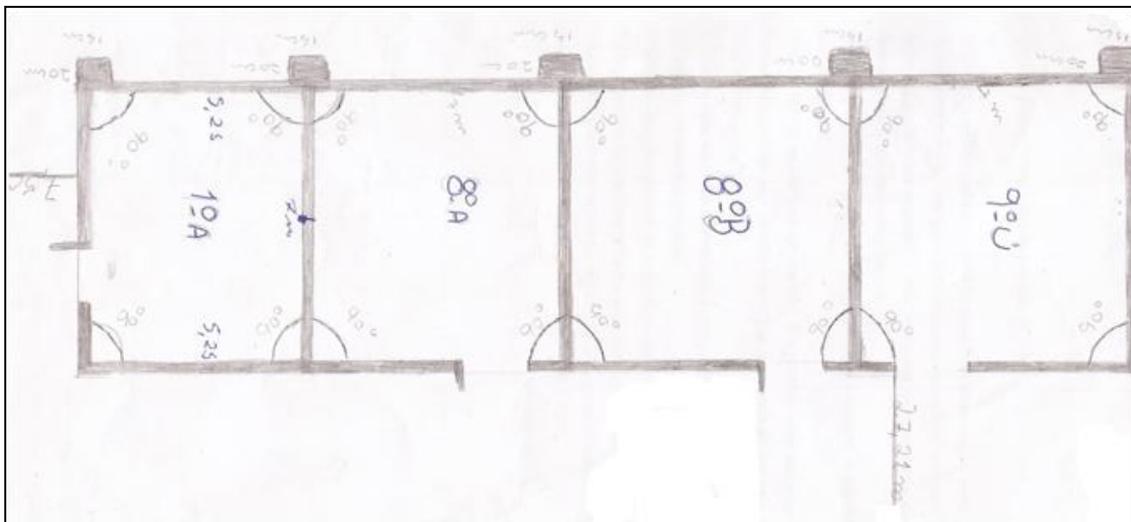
Planta baixa do pavilhão da escola construída pelo aluno 30 do 8º ano B
